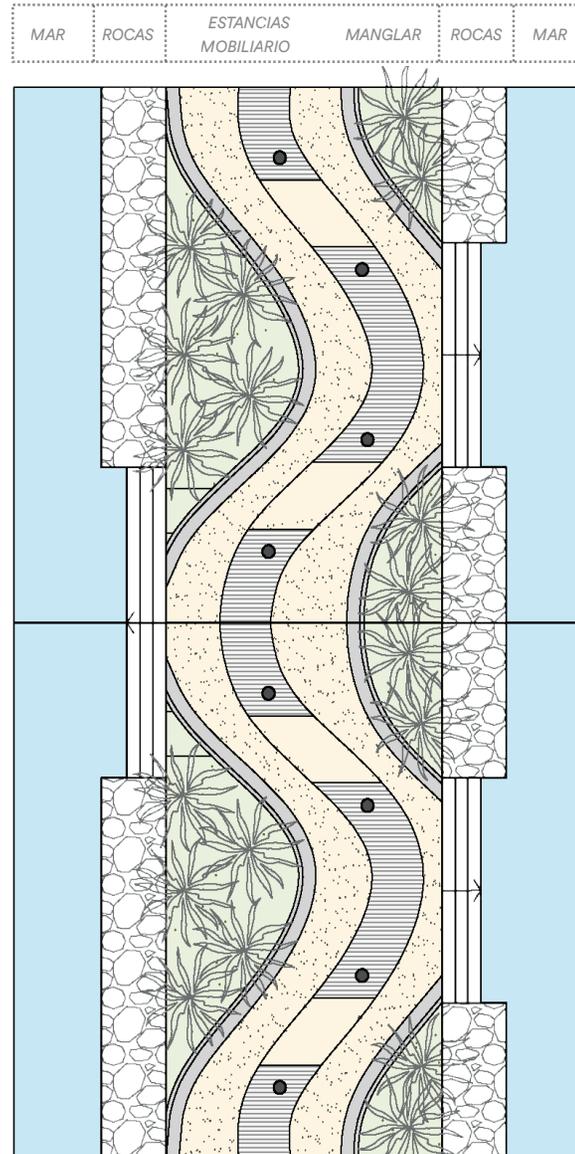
Planta modular escala 1:200 de espolón híbrido tipo A. Elaboración propia
